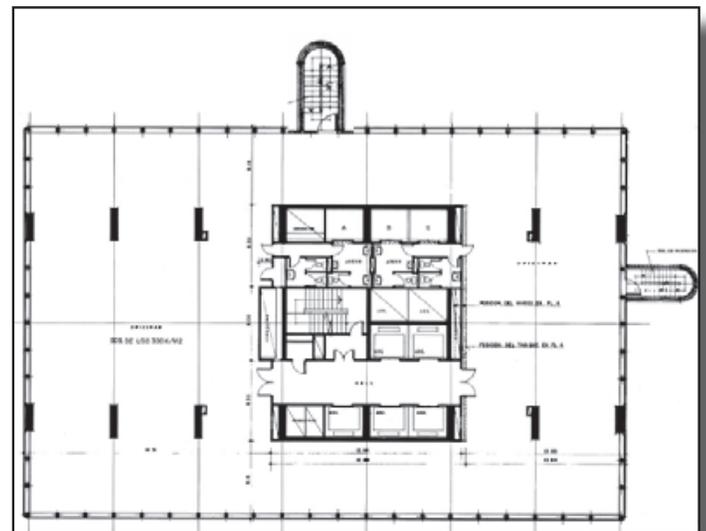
Plano de las plantas superiores donde puede apreciarse la distribución y la ubicación de las escaleras
